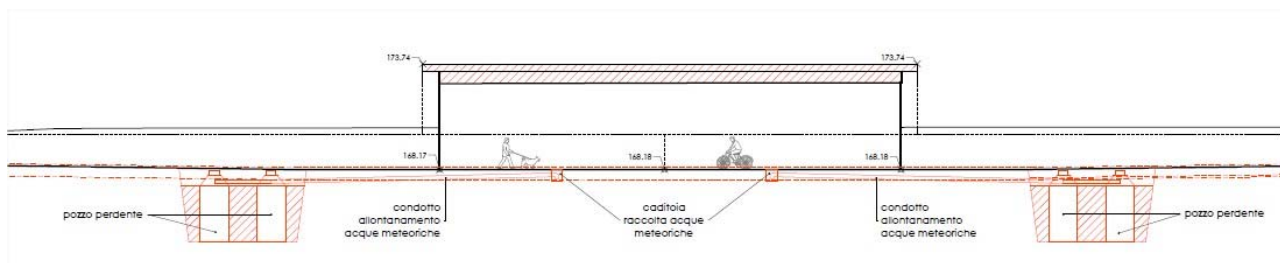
estratto Tavola di Progetto 02 –Sezione II con schema pozzi perdenti
